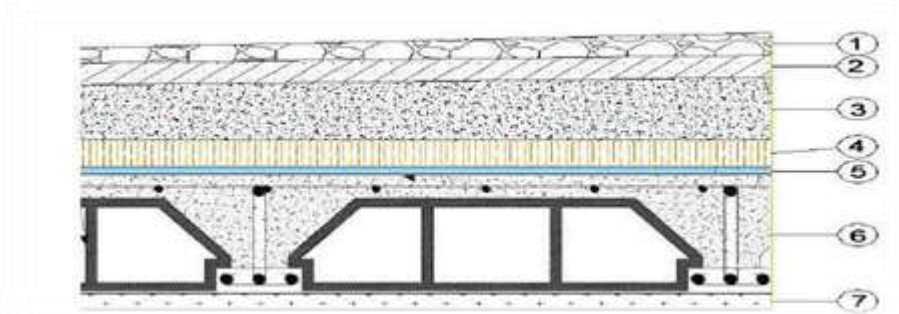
coupe de plancher terrasse inaccessible en corps creux
